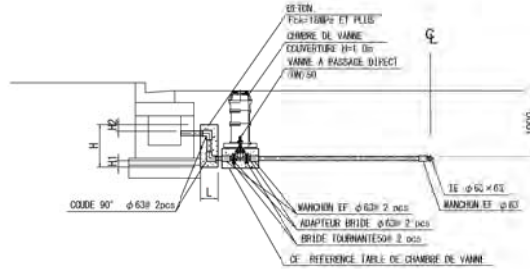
Coupe standard de la conduite de distribution (2/2)
